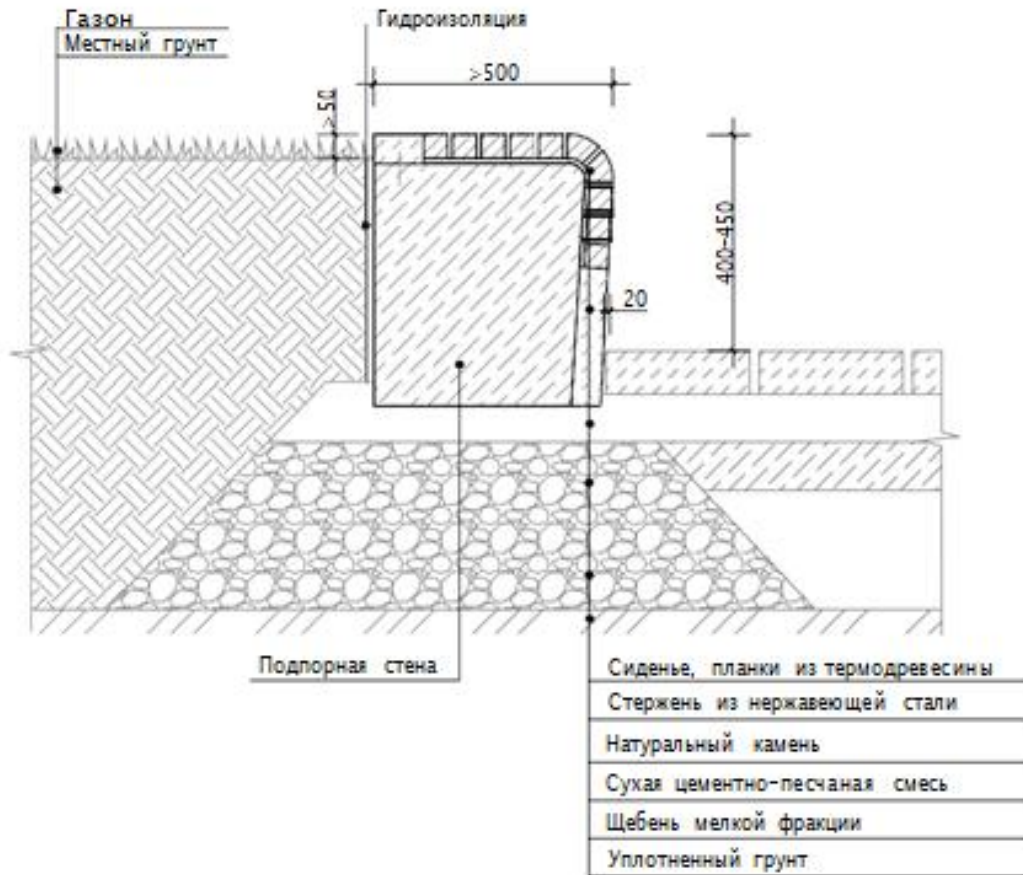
Схема устройства подпорной стены с местами для сиденья
